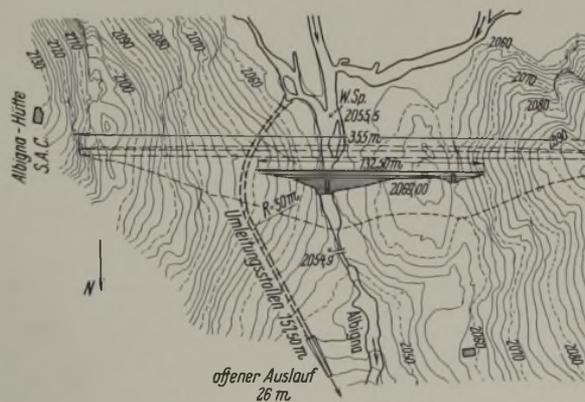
Grundriß der Hochwasserschutzmauer für 2,9 Mill. m³ Fassungsraum. Gestrichelt: Endgültige Staumauer.
